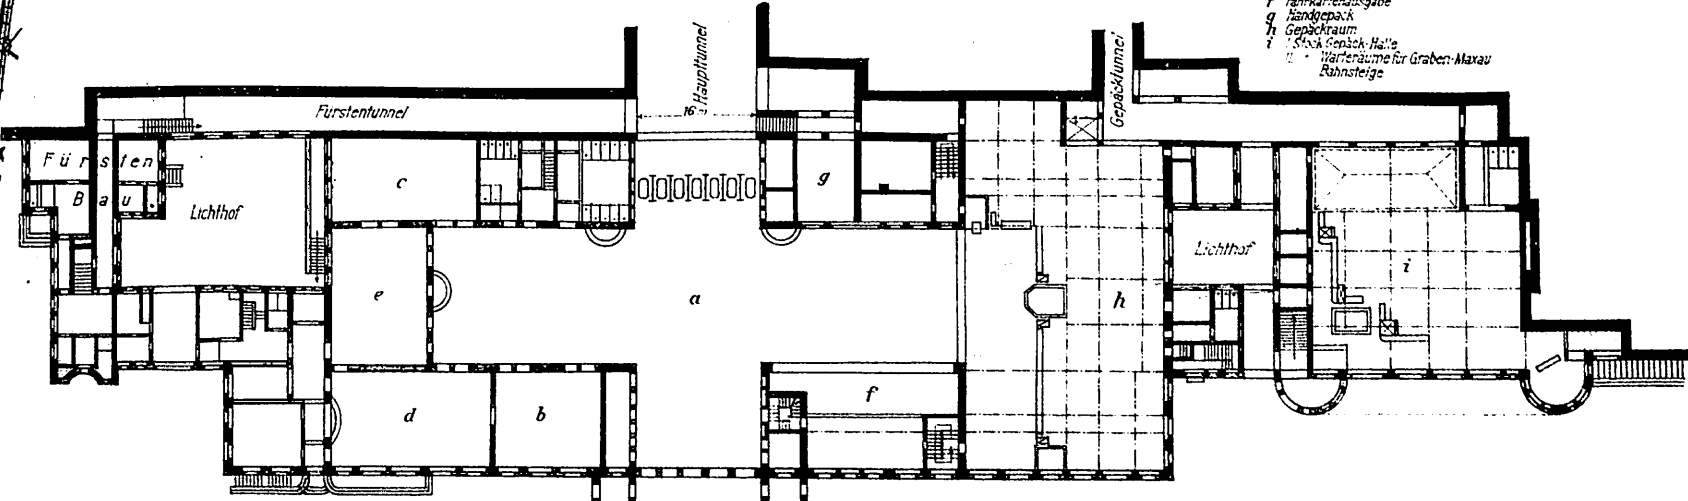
Grundriß des Empfangsgebäudes. Maßstab 1:1000.
